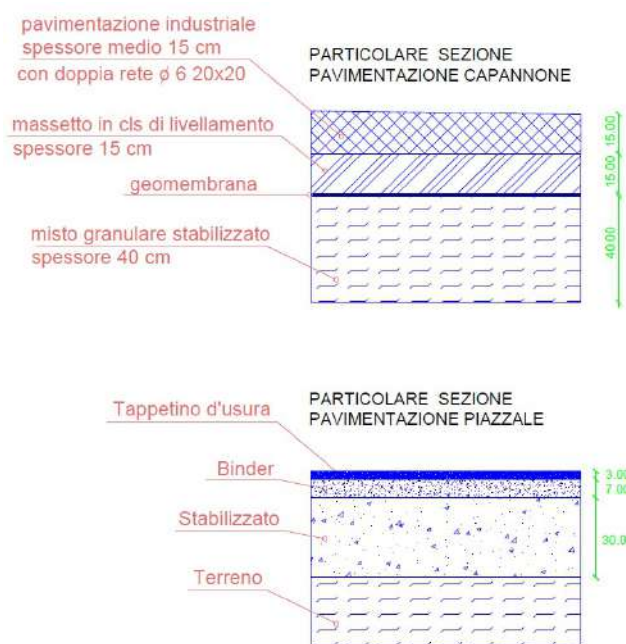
Pavimentazione dei piazzali e interna ai capannoni – Sezione tipo
